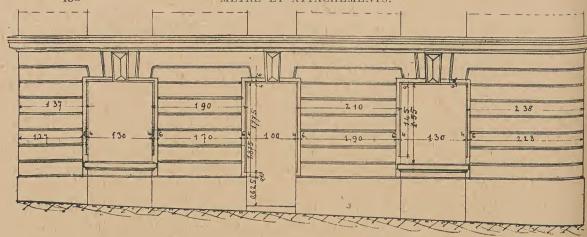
Ravalement sur cour. — Rez-de-chaussée.
